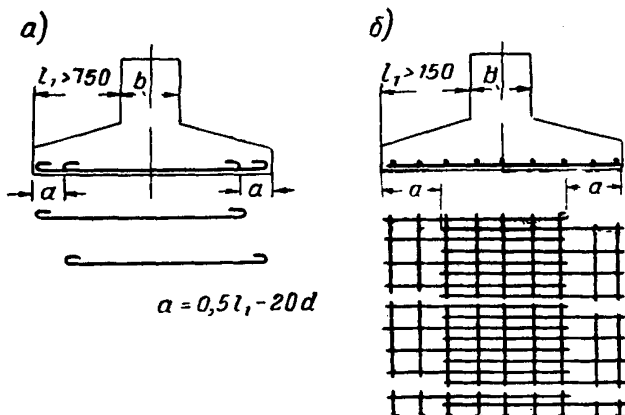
Армирование плиты железобетонных ленточных фундаментов при свесах полки плиты более 750 мм
